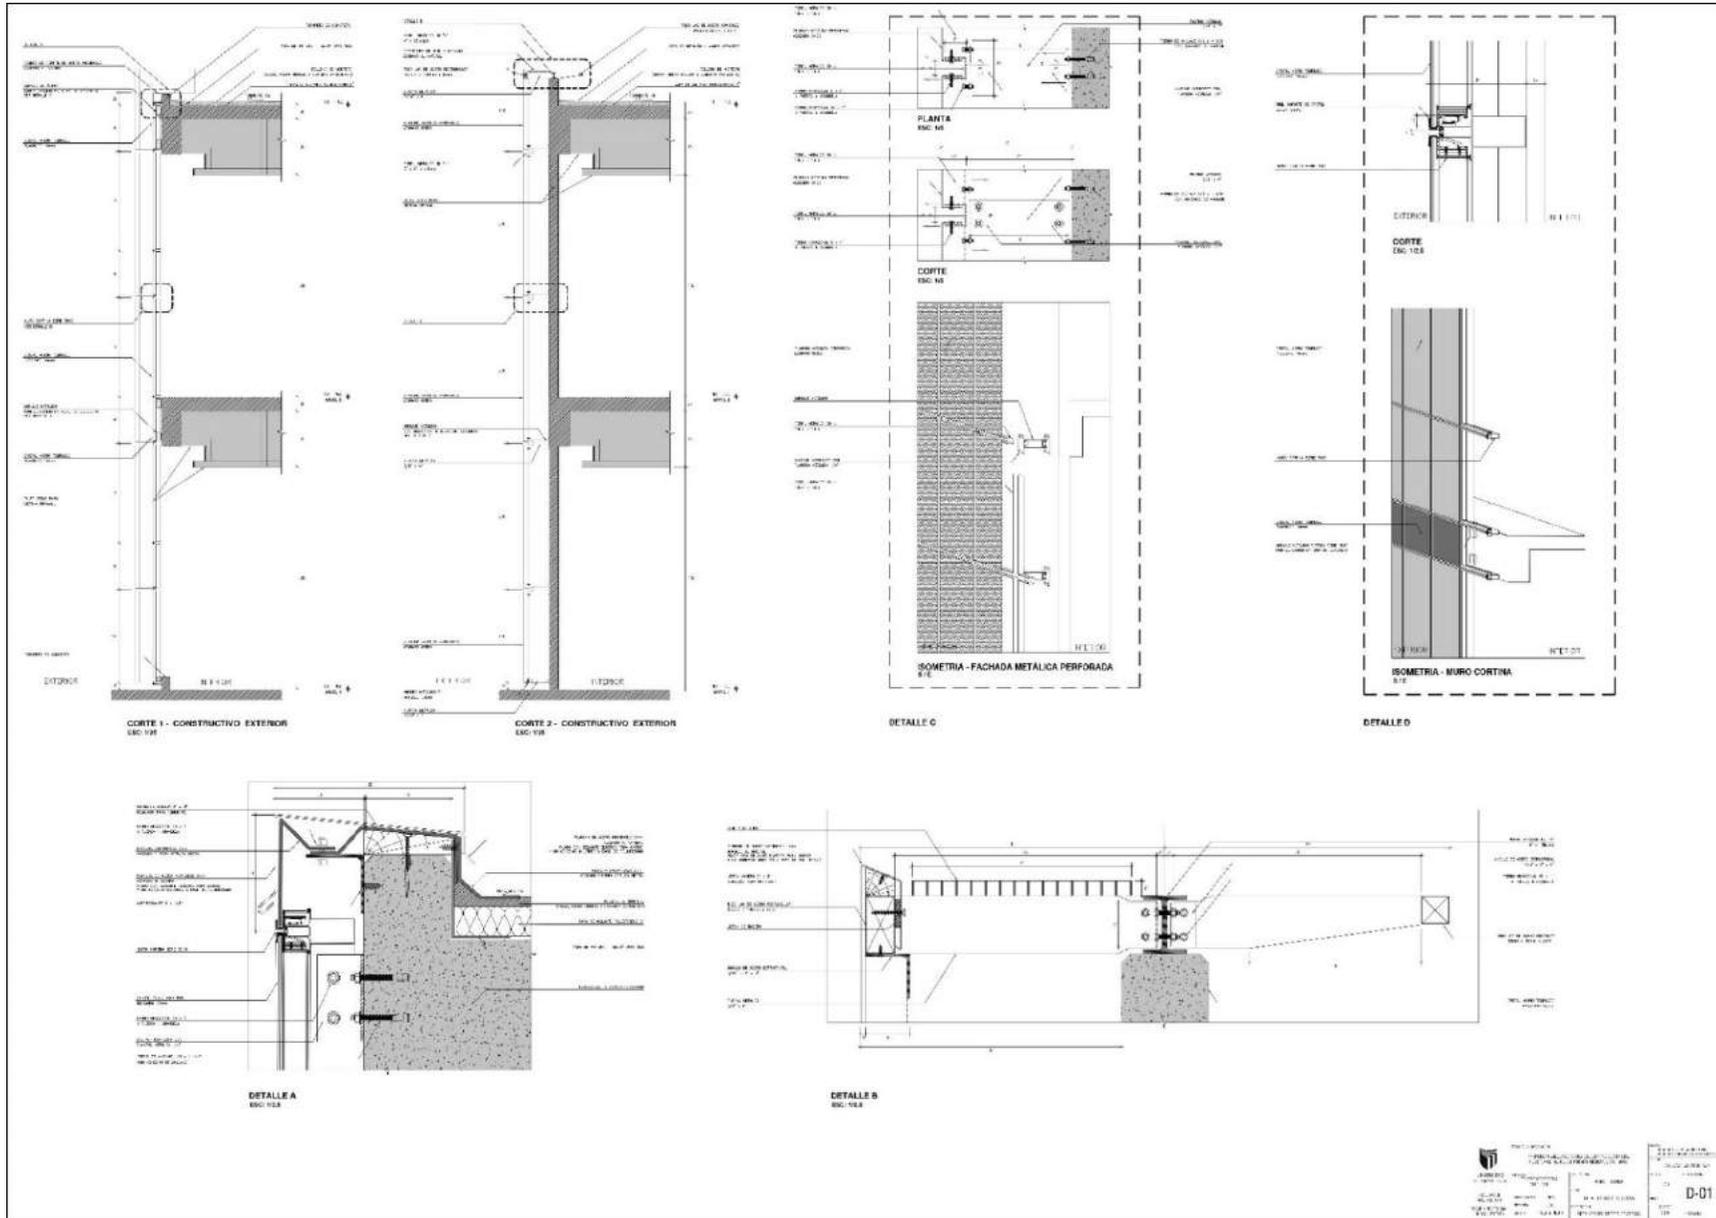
Detalles constructivos – zona comercial. Elaboración propia.
